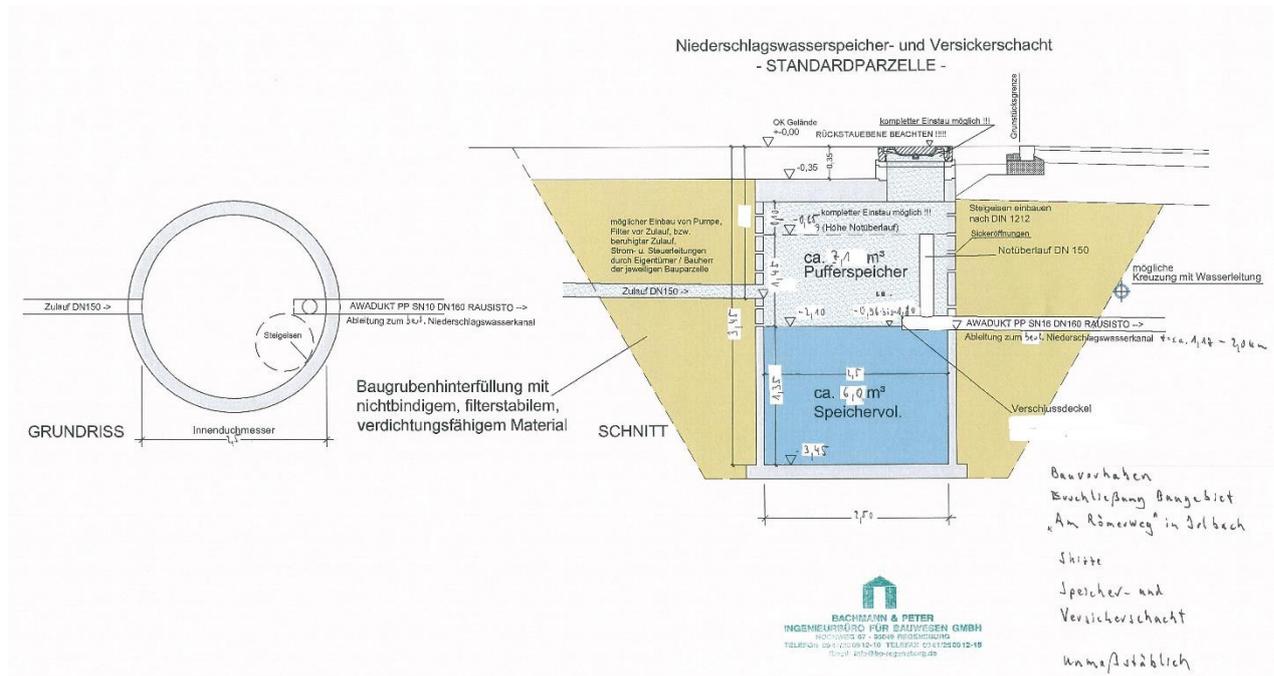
Detail Niederschlagswasserspeicher- und Versickerschacht, Standardparzelle
